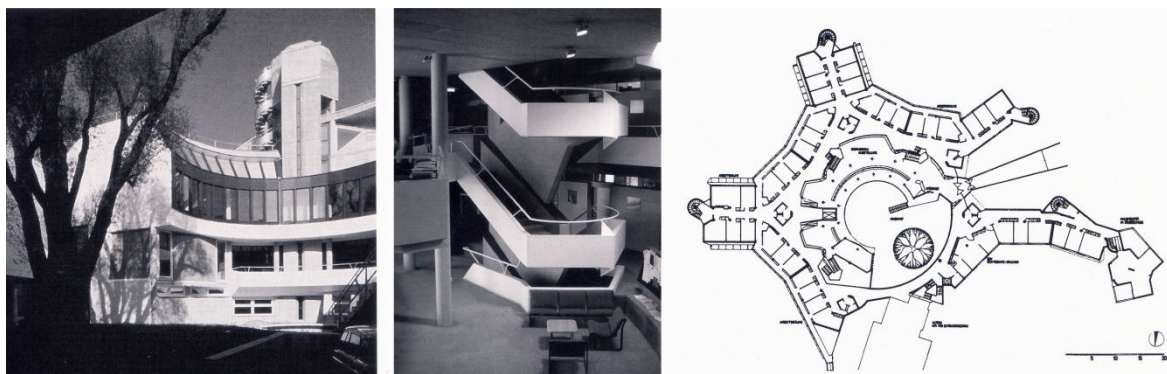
Vista geral e planta do térreo Instituto Max Planck de Física e Astrofísica. Fonte: BRAUN, 1999, p.17.
